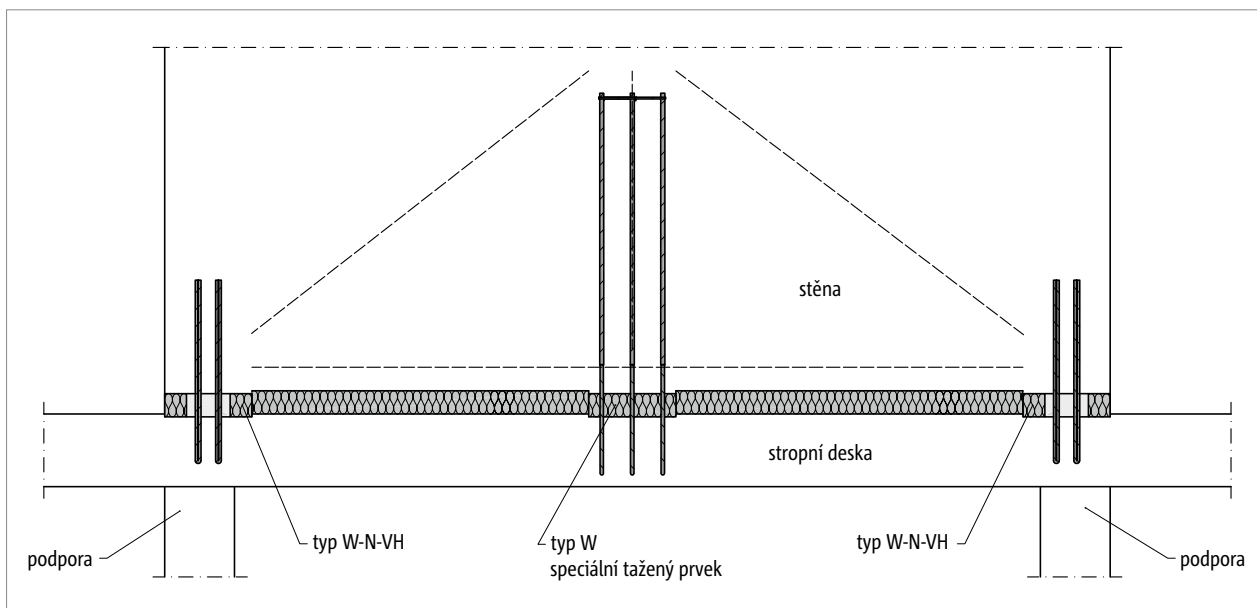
Schöck Sconnex® typ W: Tvarový styk díky zapuštění izolantu 5–10 mm do stropní konstrukce
